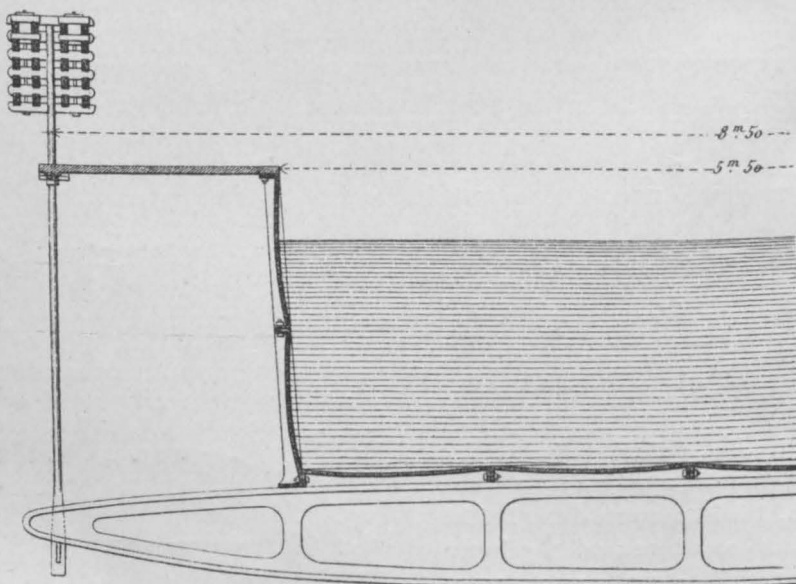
Querschnitt einer Kanal-Kettenbrücke, nach dem Entwurf von NAVIER. 1823.
